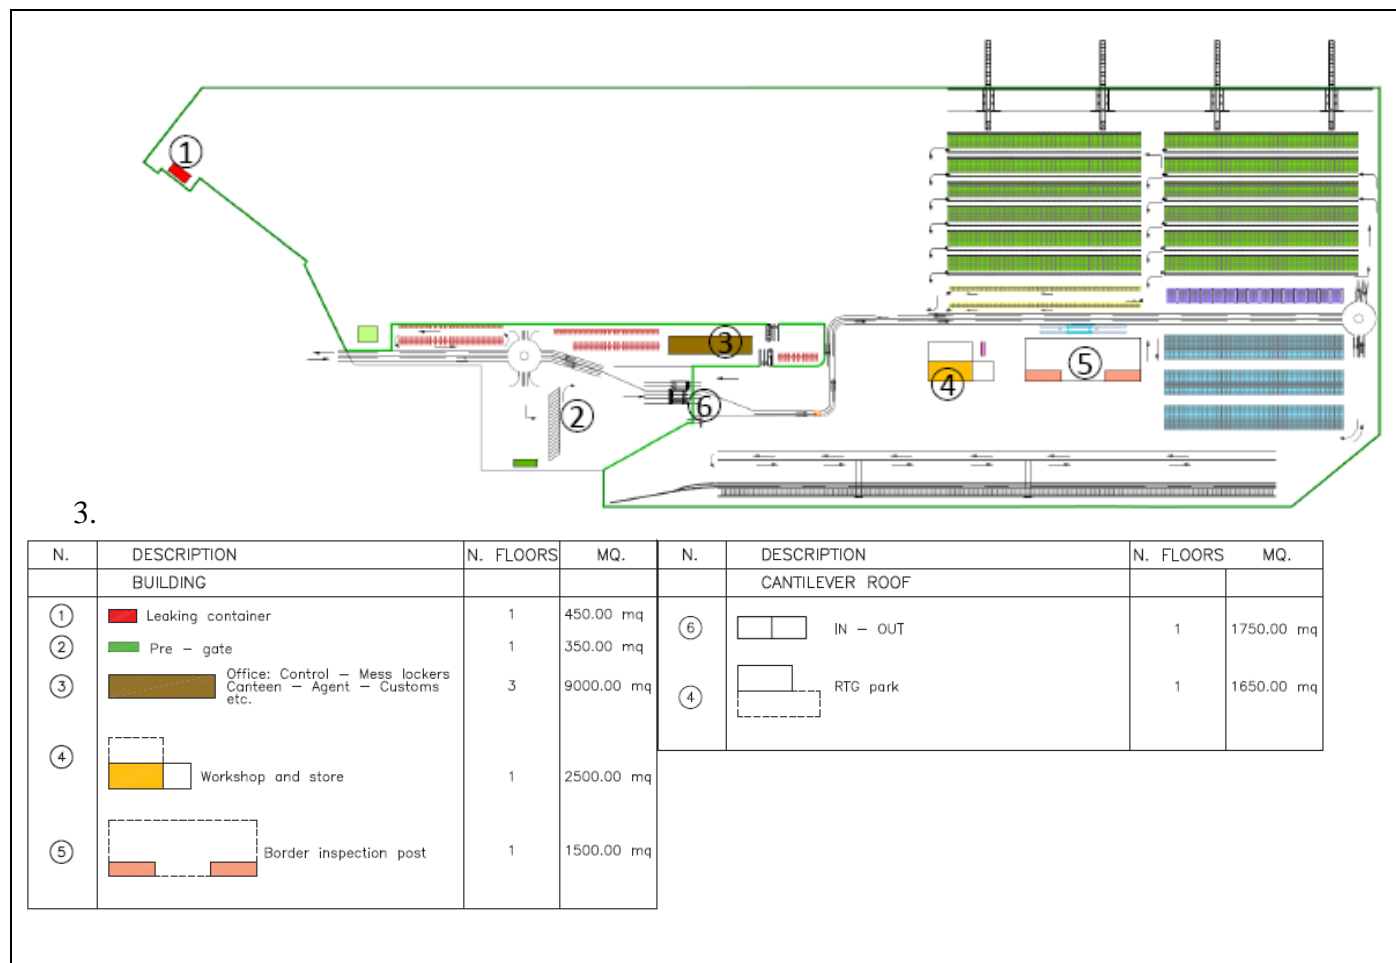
Planimetria terminal convenzionale e indicazione strutture principali.
